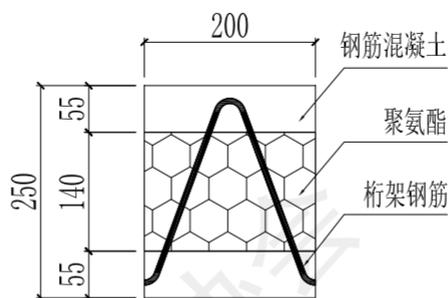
(a) 钢筋线性横向穿越非承重墙体典型单元模型
